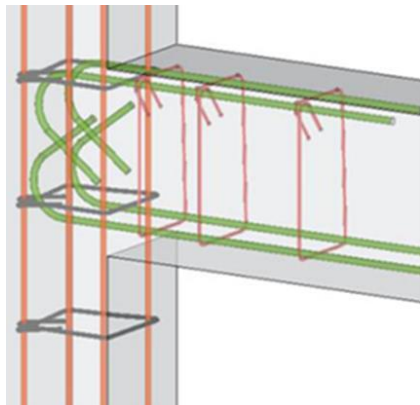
détail d'assemblage poteau-poutre en béton armé
